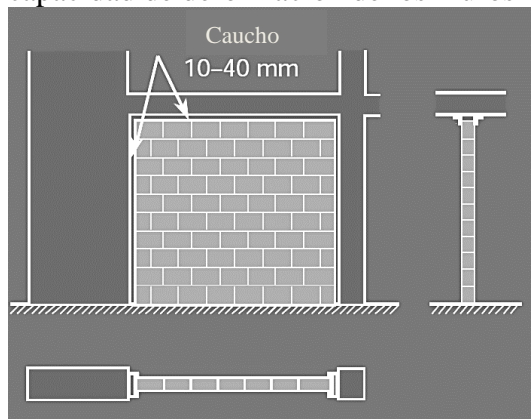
Muro de mampostería no estructural aislado del pórtico mediante junta de aislamiento (Bachmann, 2003).
